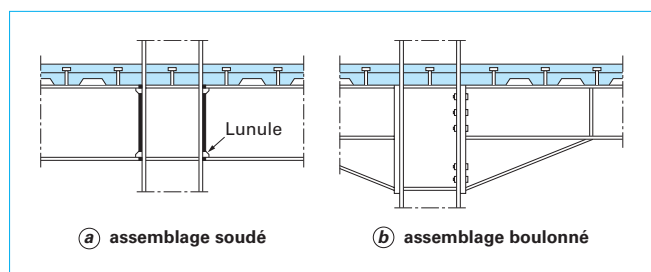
Assemblages mixtes surrésistants pour zones sismiques
